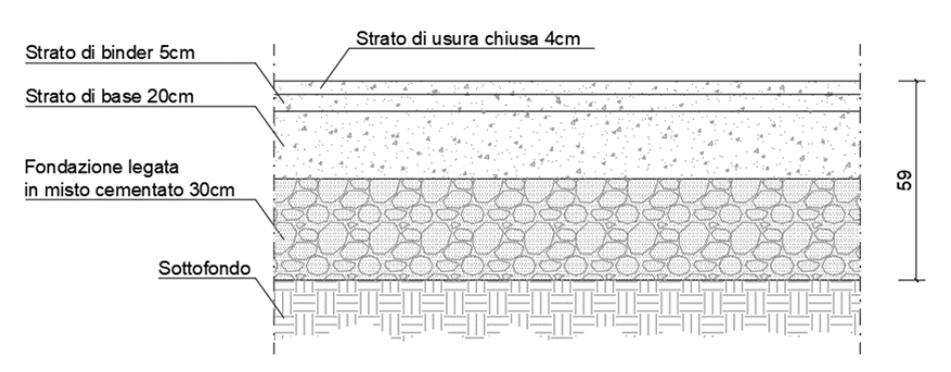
Pacchetto di ripristino pavimentazione nelle viabilità locali TIPO P5C
